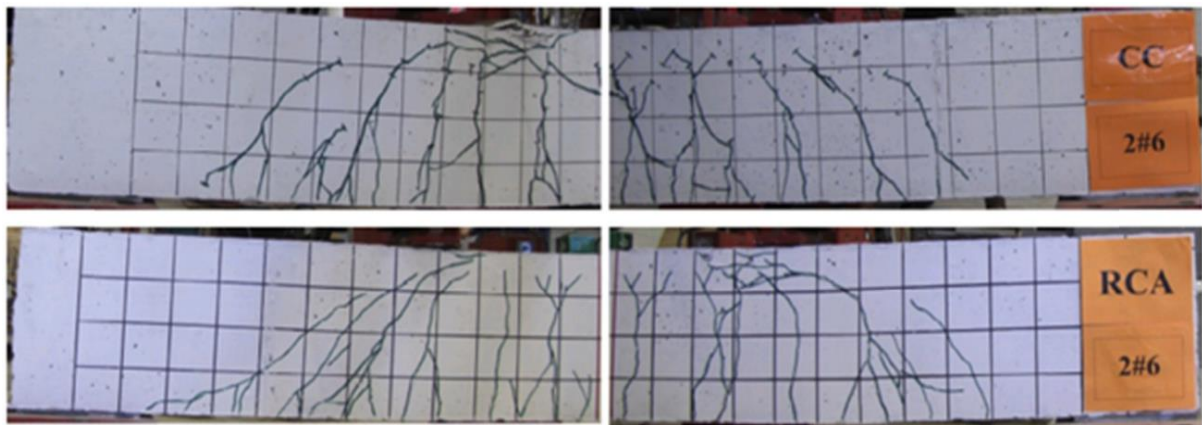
Mode de fissuration en flexion de poutres en BGN et BGR avec 100 % GR [44].
